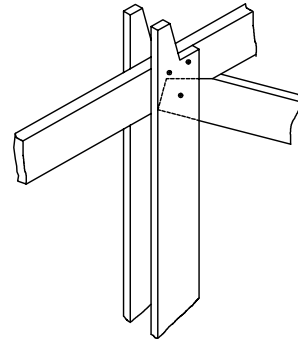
Ligação do banzo superior para treliça tipo Howe.
